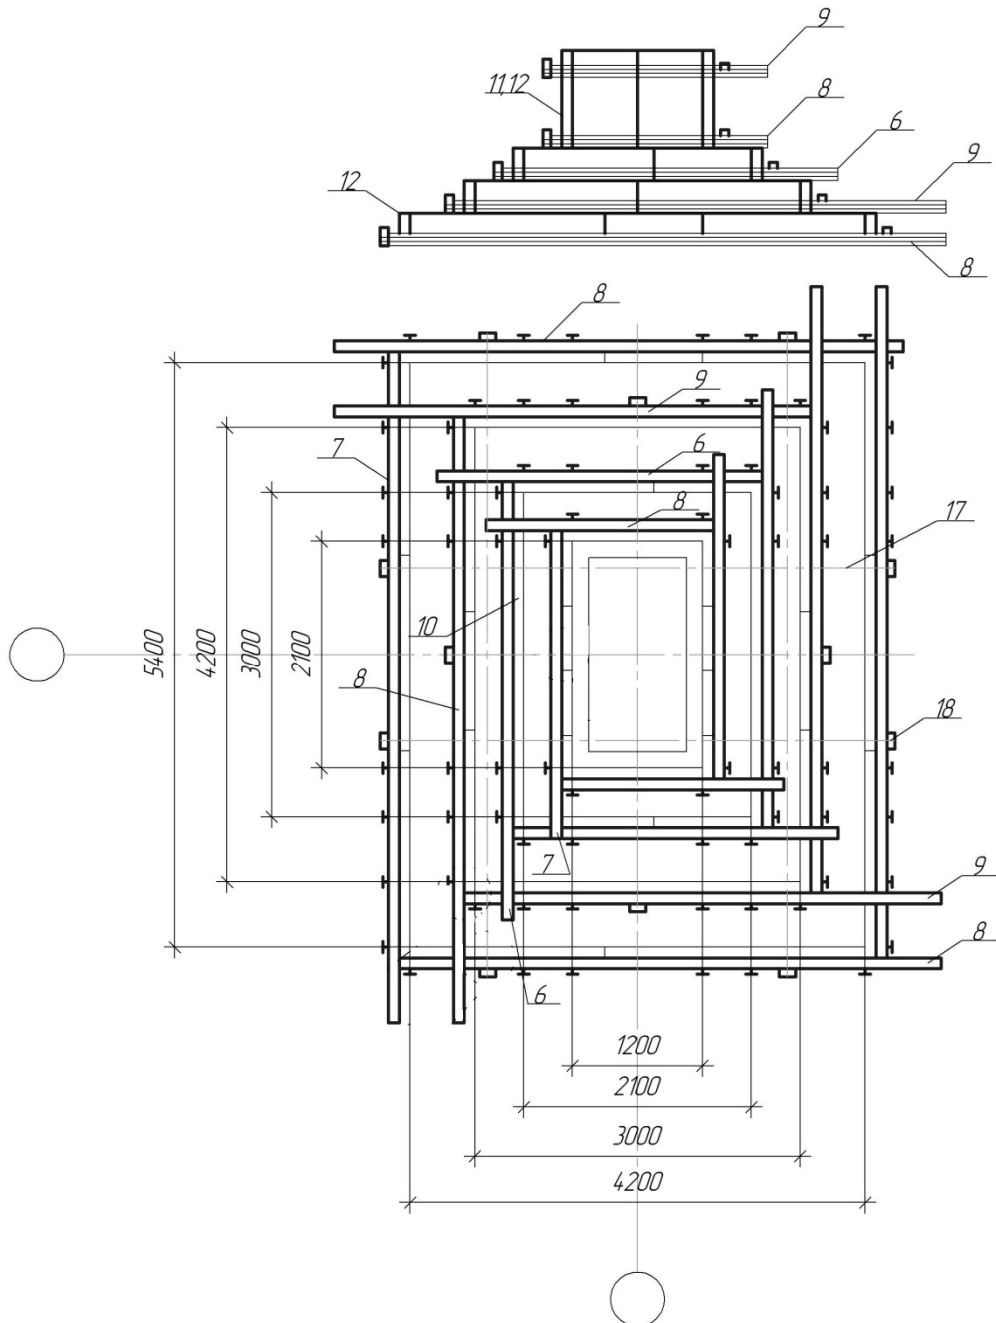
Пример конструирования мелкощитовой опалубки фундамента (ЦНИИОМТП): а - раскладка щитов; б – установка наружных угловых элементов и схваток:
